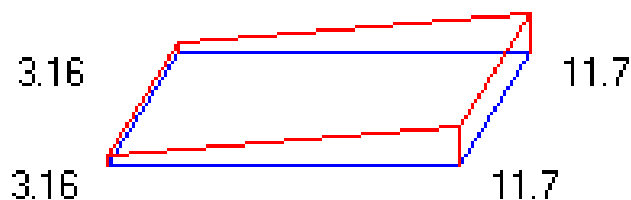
Эпюра напряжений под подошвой фундамента (тс/м²).
